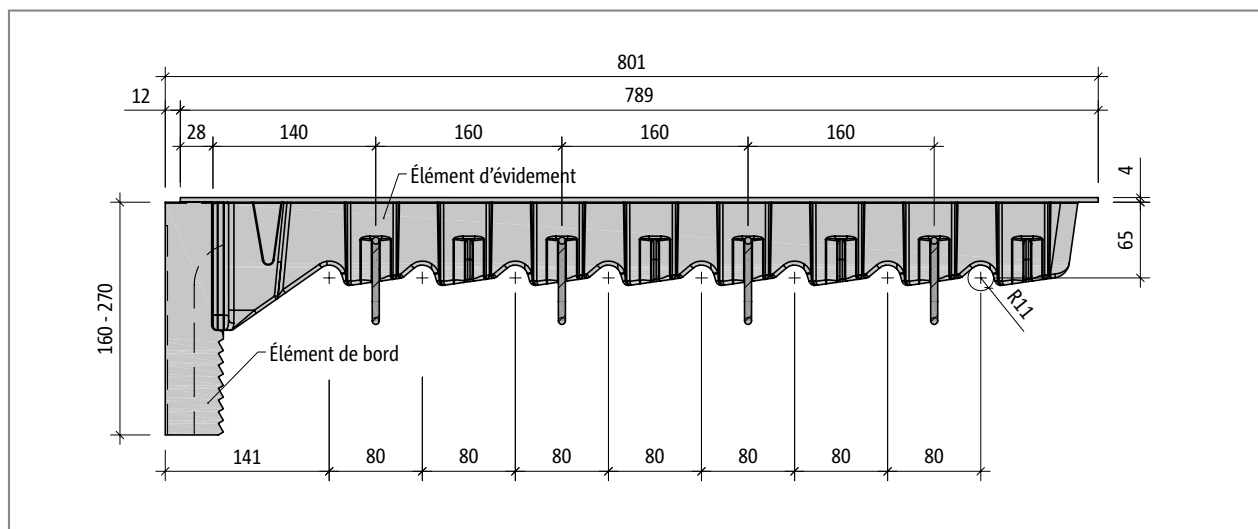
Schöck IDock® : coupe transversale, IDock1
